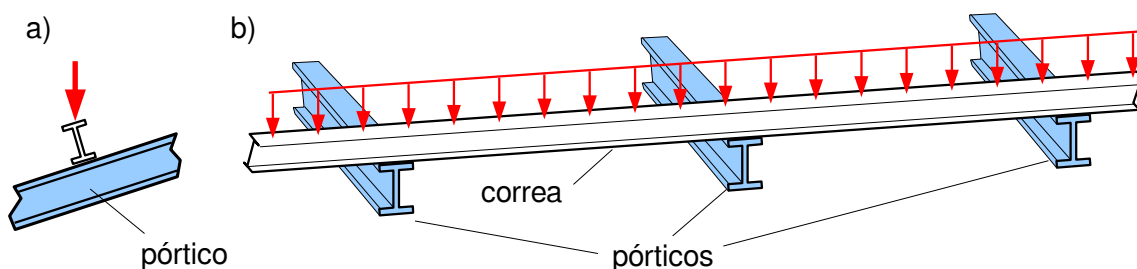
La correa como viga continua trabajando en flexión esviada. a) Vista en el plano del pórtico. b) Vista en perspectiva.
